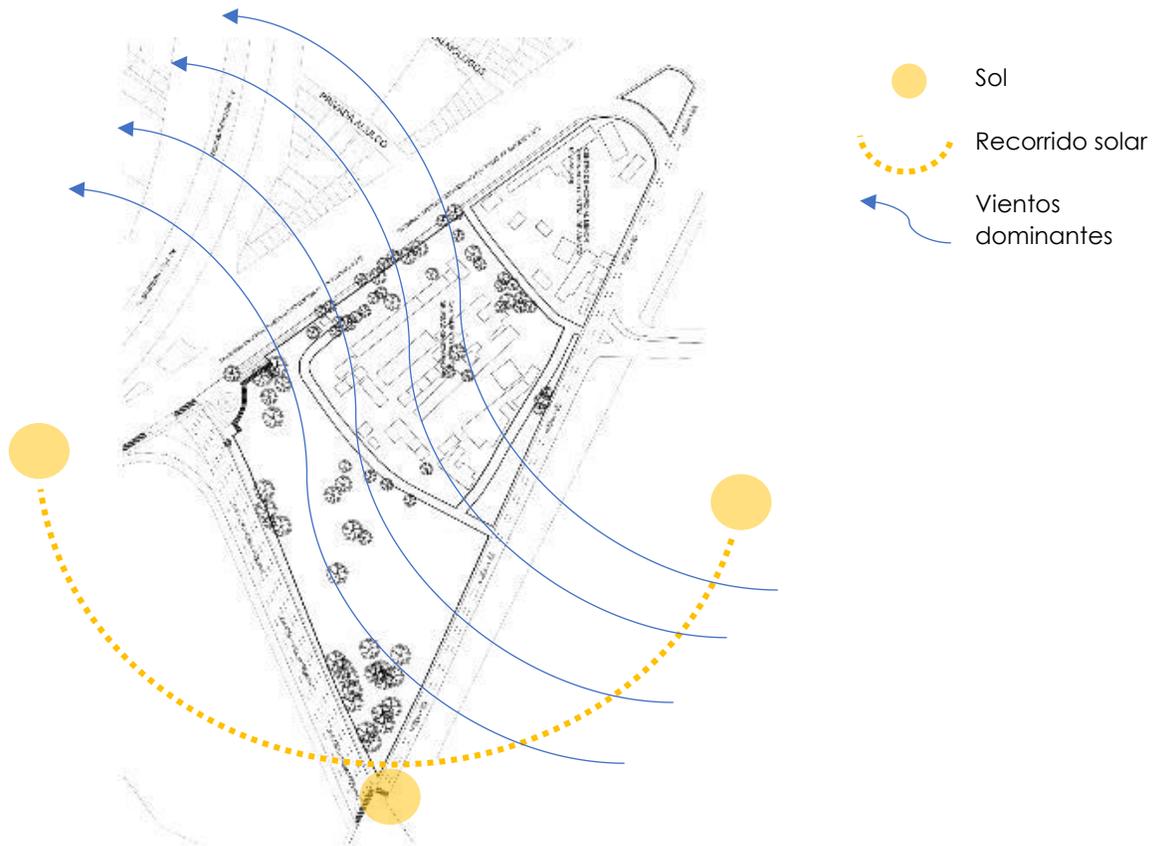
Plano de Conjunto con recorrido solar de Oriente a Poniente. Imagen propia
